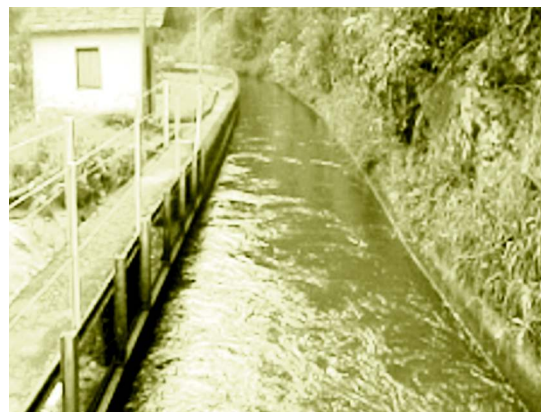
Trecho de um canal de adução escavado em rocha e revestido
